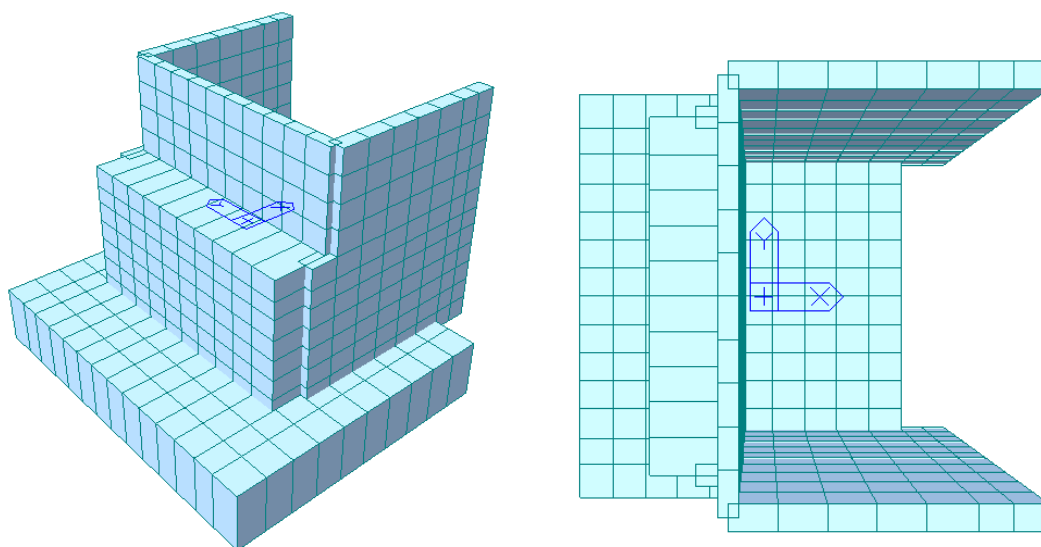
Viste 3d del modello di calcolo spalla B (fissa)
